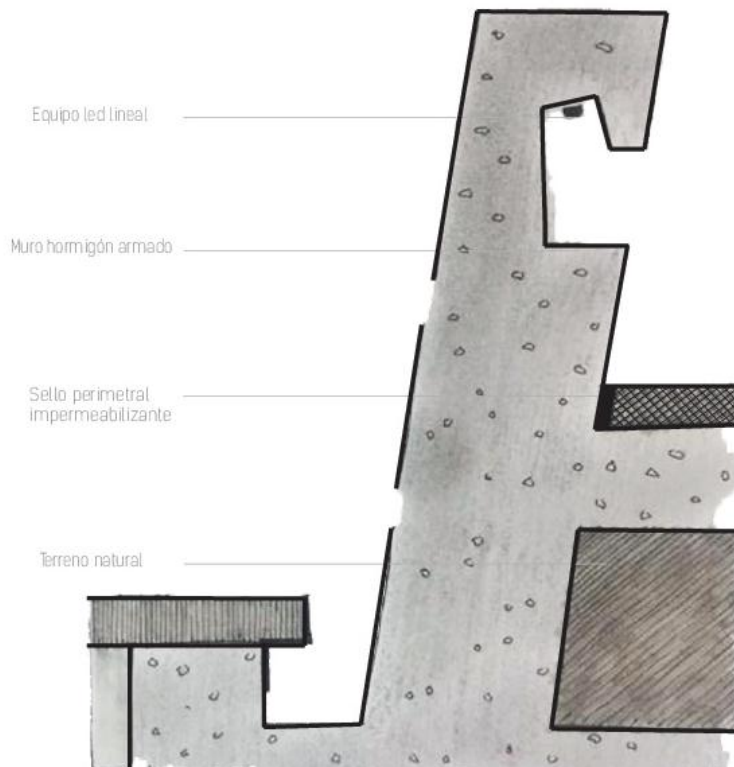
Detalle constructivo museo de Atacama. Ilustración autor
